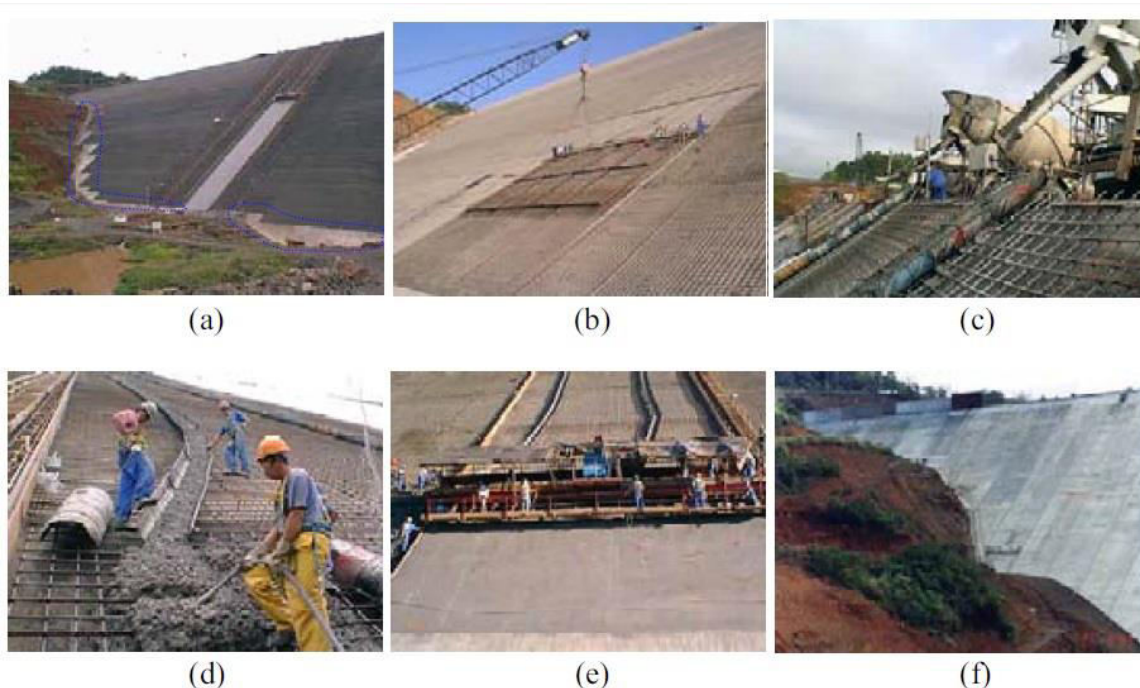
FASES DE CONSTRUÇÃO DA BARRAGEM DE CAMPOS NOVOS
